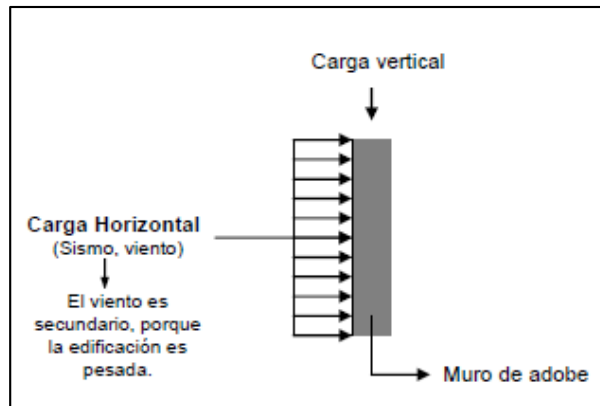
Cargas en un muro de adobe (Zelaya, 2007)
